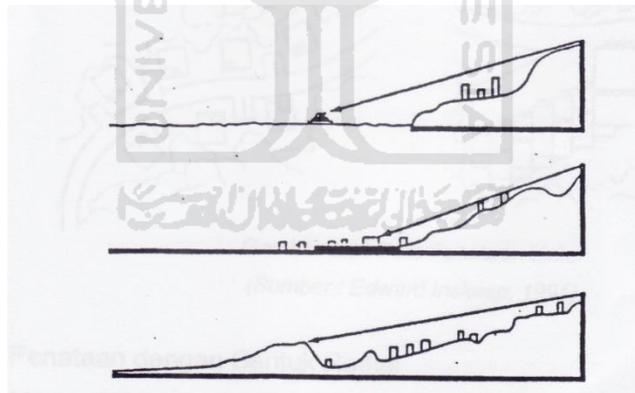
Contoh Pengembangan View ke Arah Pantai
